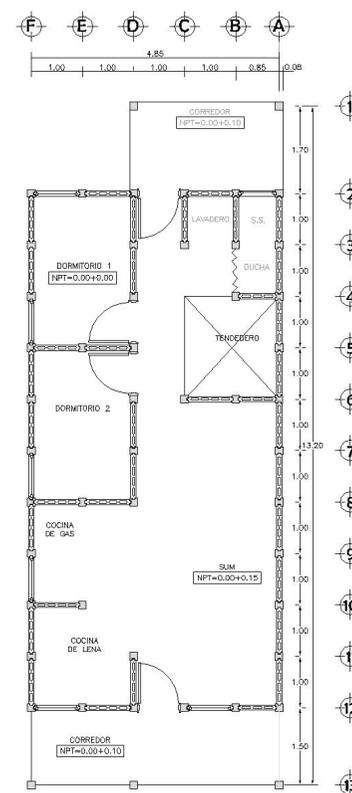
Esquema de planta arquitectónica de vivienda de panel bloque.
